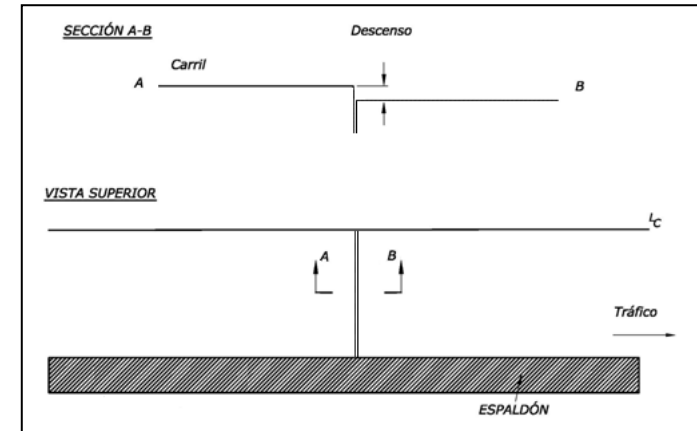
Esquema Escalonamiento entre Calzada y Juntas- Pavimento Rígido
